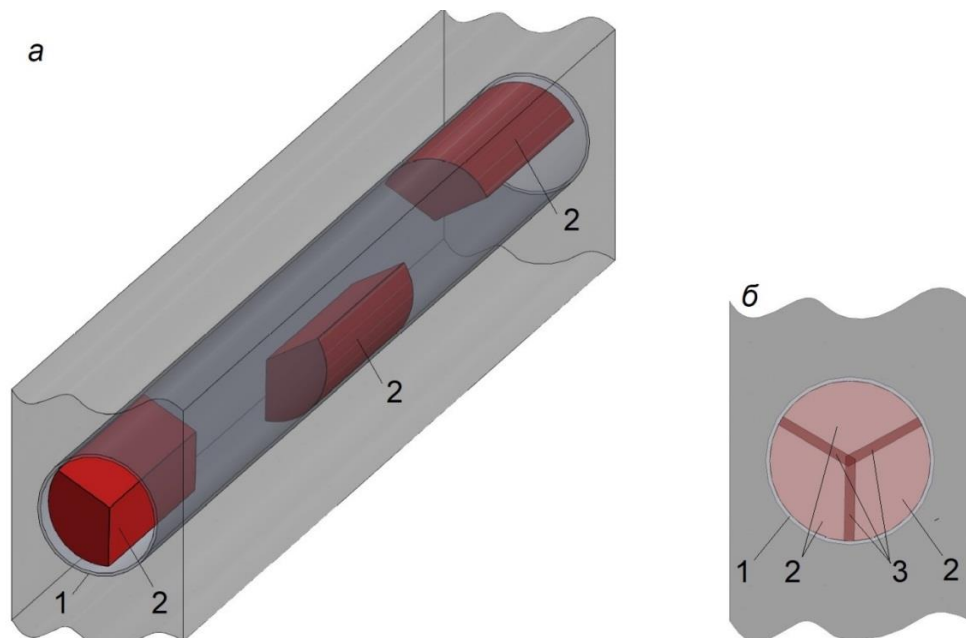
Проходка системы вентиляции с КИД: 1 – проходка (закладная труба); 2 – блок радиационной защиты; 3 – область взаимного перекрытия блоков
